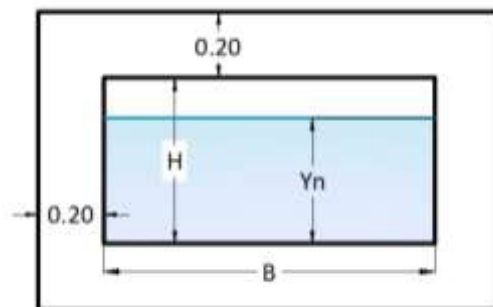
Esquema de sección transversal de ductos cajón
